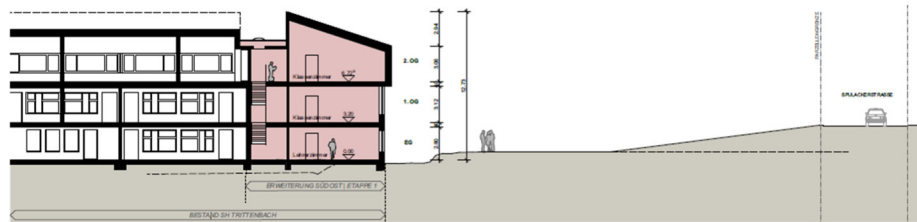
Disposition 01 | Gebäudeschnitt B-B
